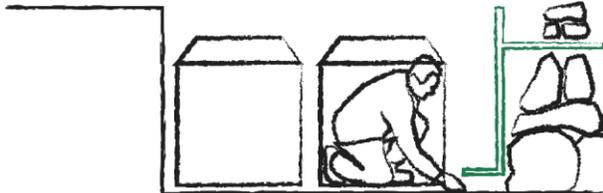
Instalación de tubería para tanques de almacenamiento. Fuente: elaboración propia.
